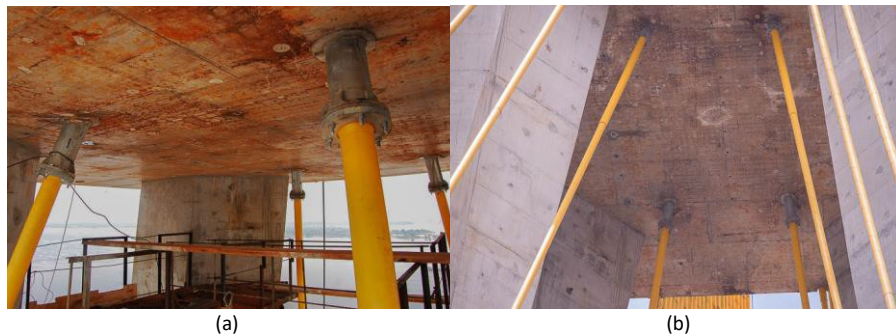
Laje do mastro central durante construção (a); e em 2017 (b). Fonte: Acervo próprio.
